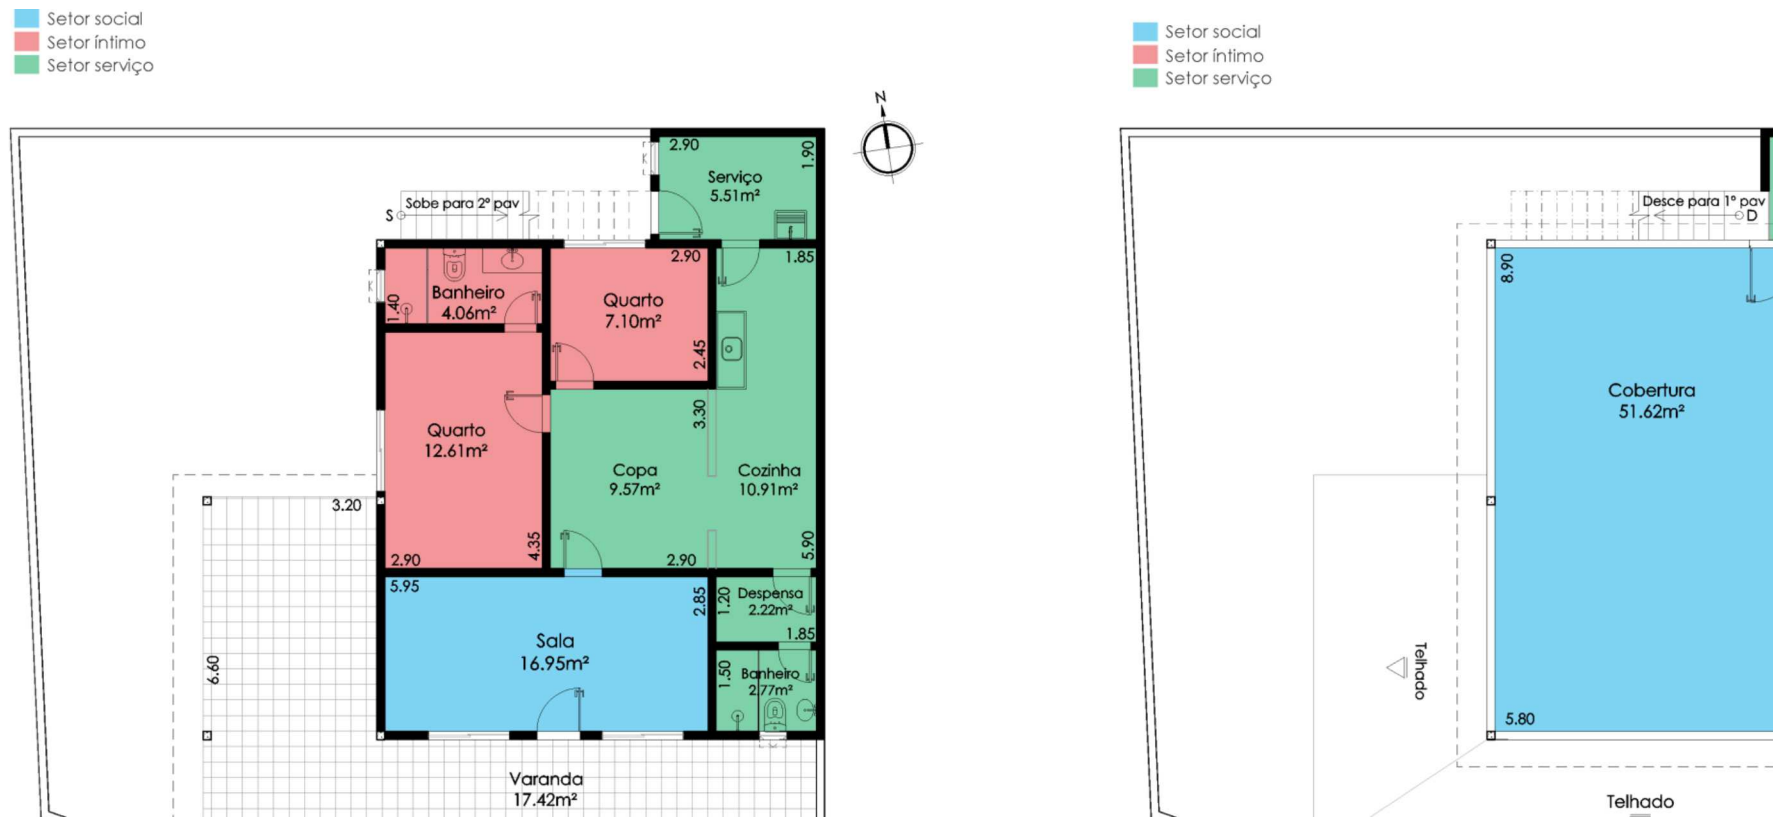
Planta baixa e Setorização do Solar Tabuleiro, 1
